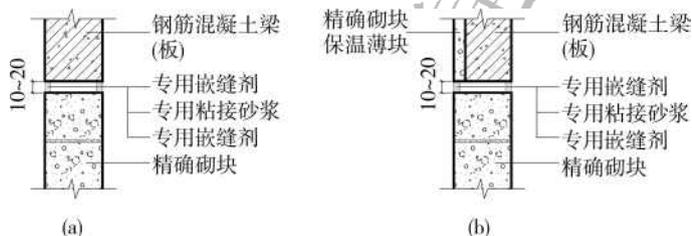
砌块墙体顶部与钢筋混凝土梁、板交接处刚性连接构造
